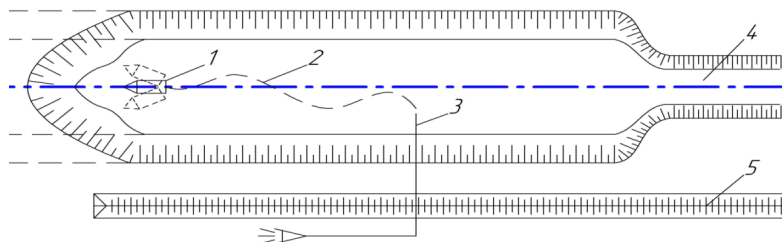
Схема разработки узкопрофильных каналов малогабаритными землесосными снарядами: 1 – землесосный снаряд 8ПЗУ; 2 – плавучий пульпопровод; 3 – распределительный пульпопровод; 4 – пионерная траншея; 5 – дамба обвалования.
